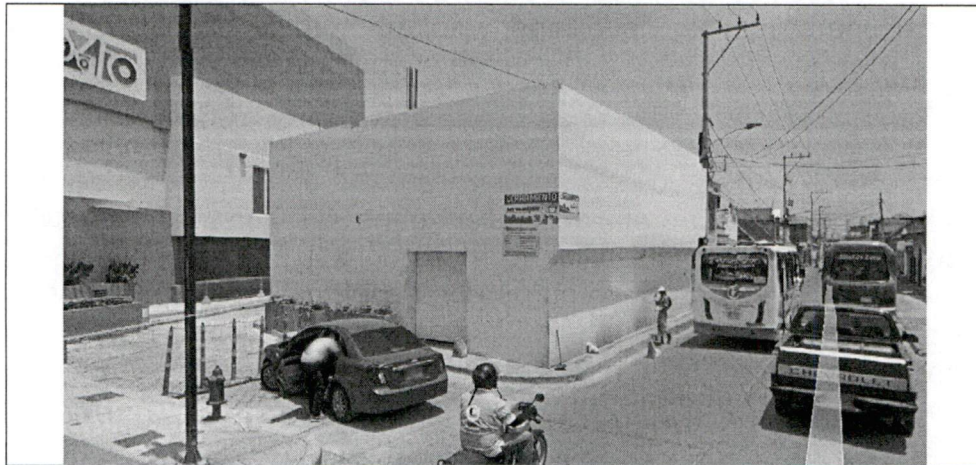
Fachada del inmueble objeto de prorrogación de cerramiento está ubicado en el barrio Espinal Cra. 14 # 31-106.
